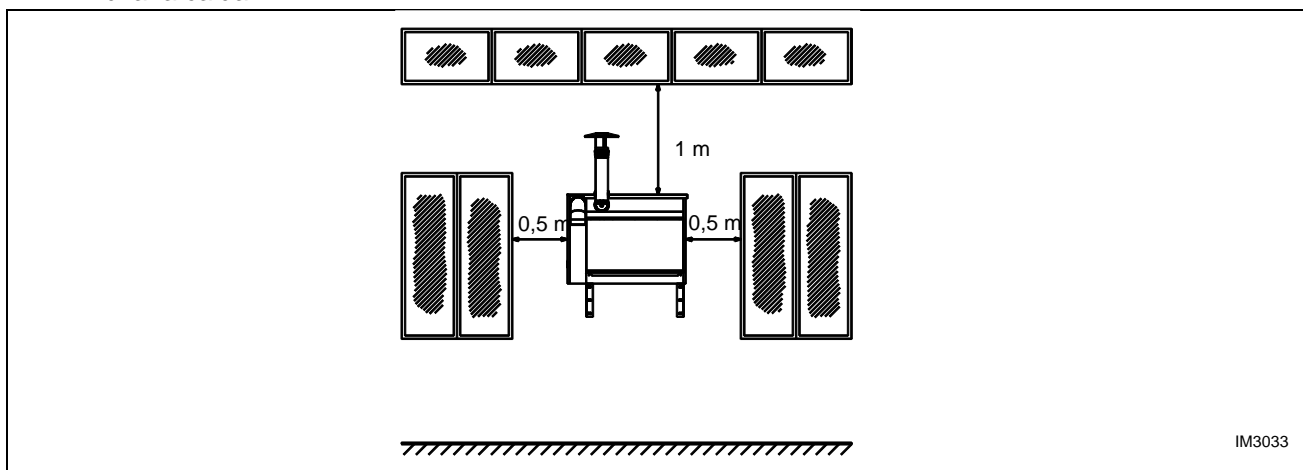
DISTANZE DI RISPETTO DA APERTURE PRESCRITTE DAL D.M. 12.04.96
